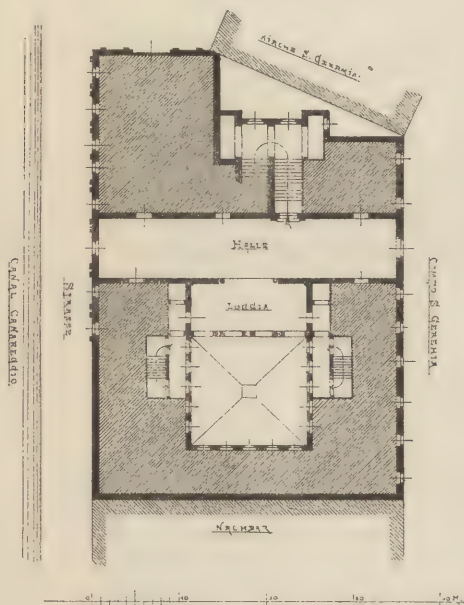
Palazzo Labia zu Venedig. Grundriss.
